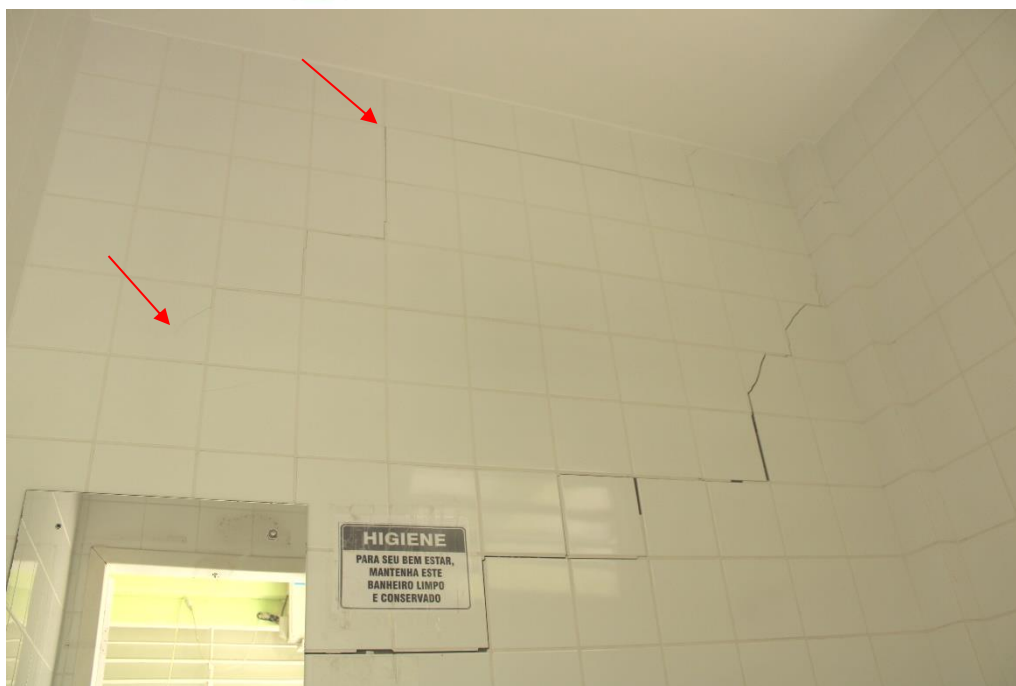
Em detalhe a Foto prévia, destacando trincas diagonais no revestimento cerâmico e, por obvio, na alvenaria.
